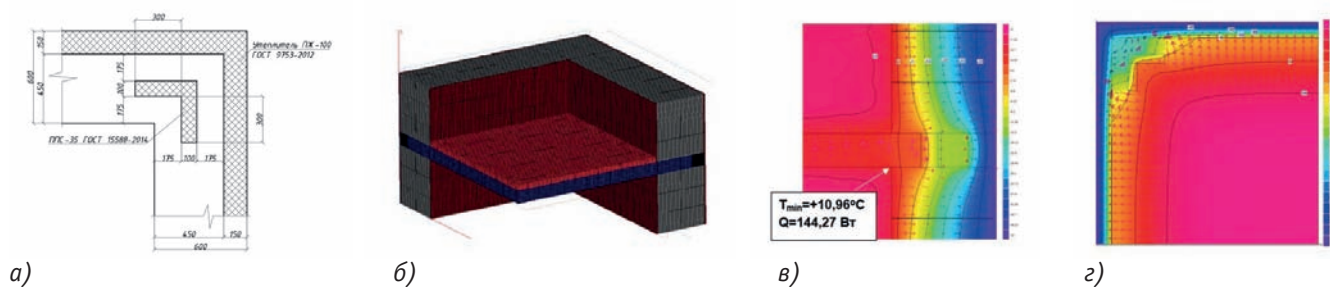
Результаты теплотехнического расчёта углового участка примыкания наружной стены к междуэтажному перекрытию с перфорацией и теплоизоляцией торца: а) конструкция узла; б) расчётная модель; в) температурное поле в вертикальном разрезе по внутренней плоскости стены; г) направления теплового потока в горизонтальном разрезе по середине толщины плиты. Составлено авторами по результатам теплотехнических расчётов
